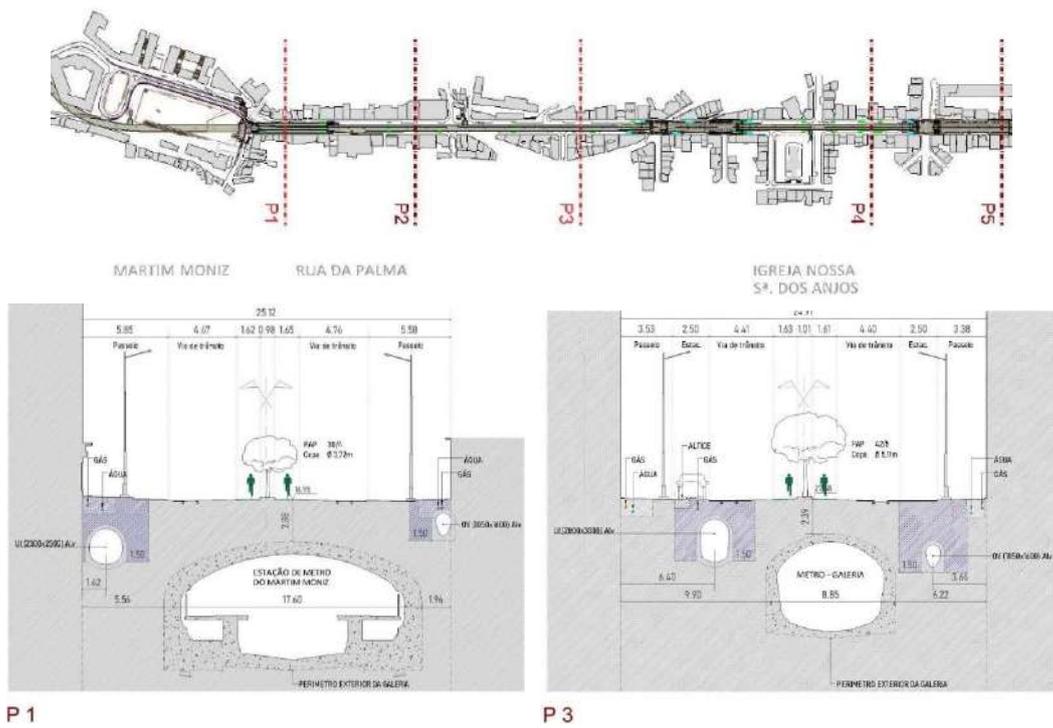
Planta e perfis P1 e P3 com identificação das infraestruturas de subsolo
